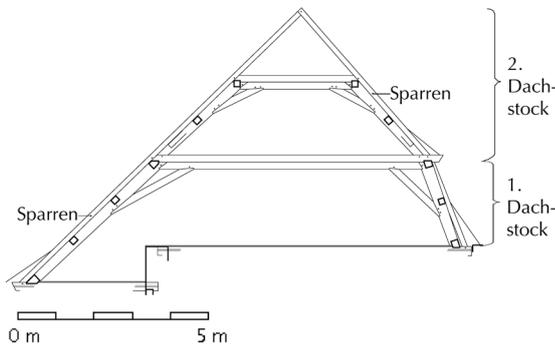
(rechts): Glockendach, als mehrstöckiges Dachgerüst abgezimmert. Memmingen, Westertor, 1660 (i/d).
